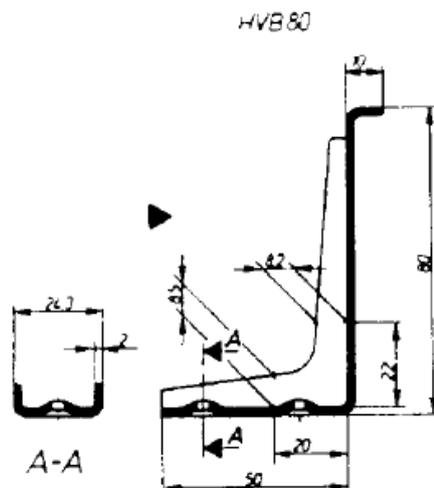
Conector não soldado Hilti (Crisinel 1990)
